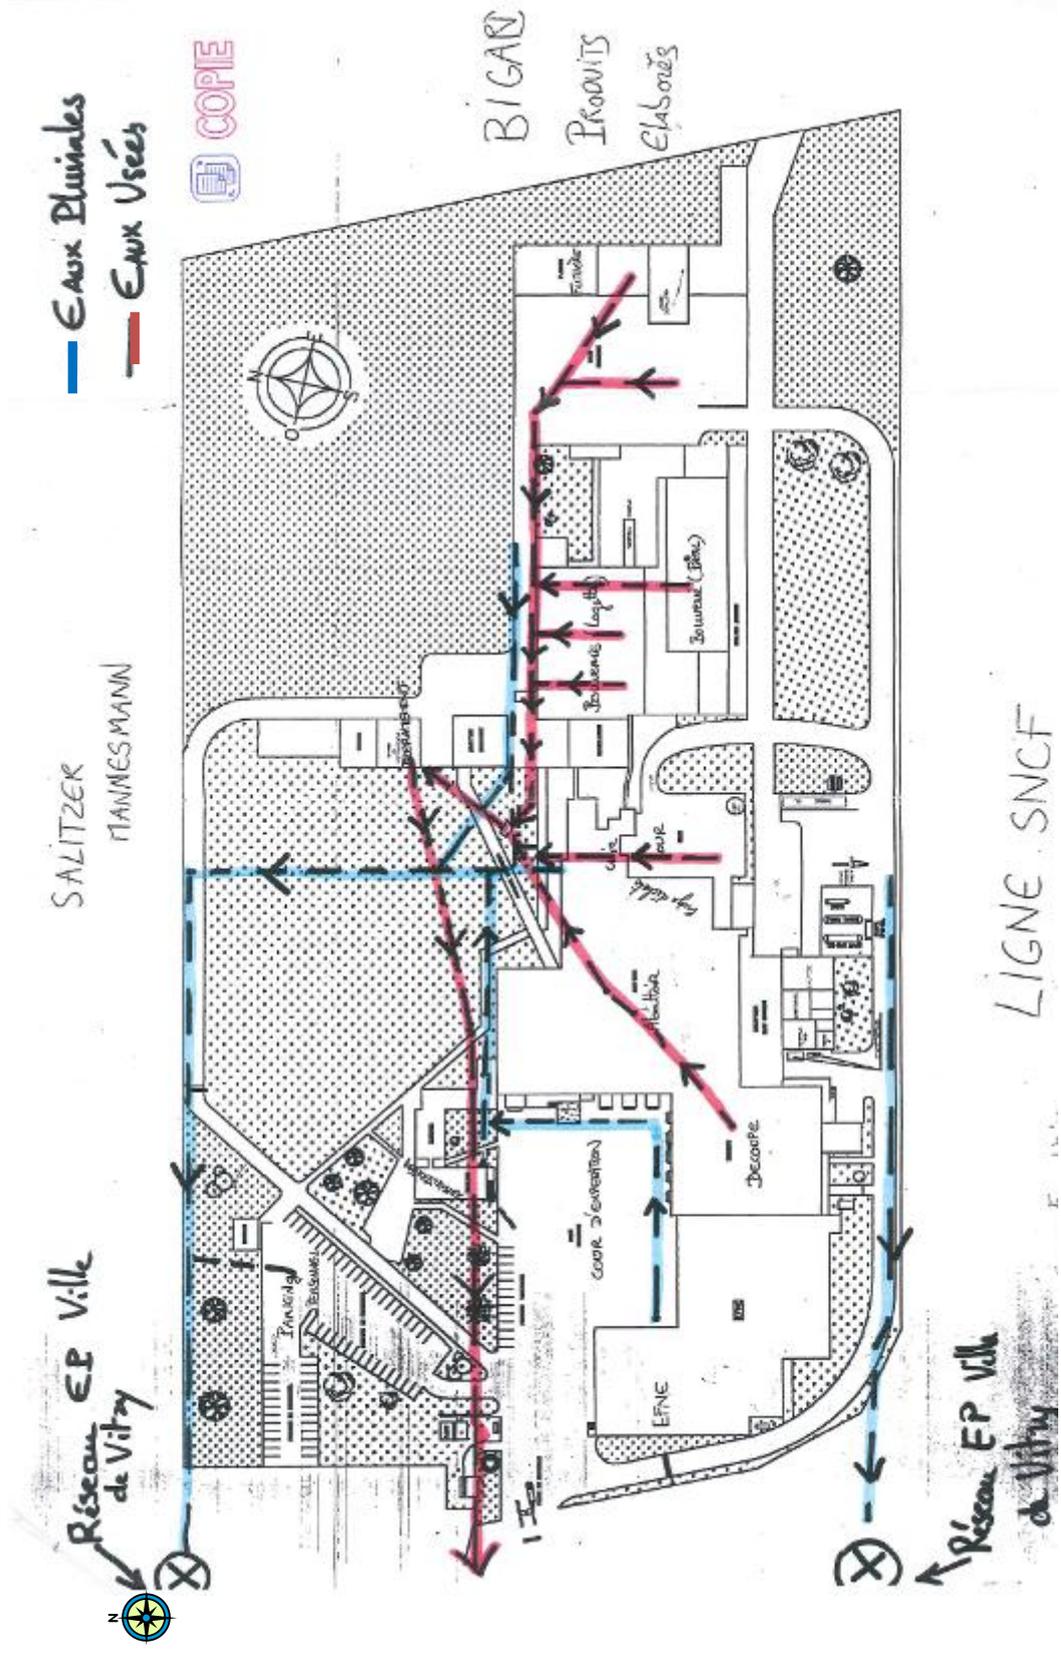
Plan de raccordement du site Bigard Abattoirs.
